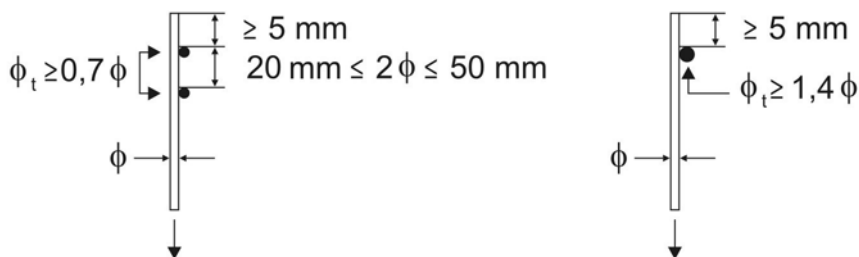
Ancoragem de armadura transversal por meio de barras soldadas
